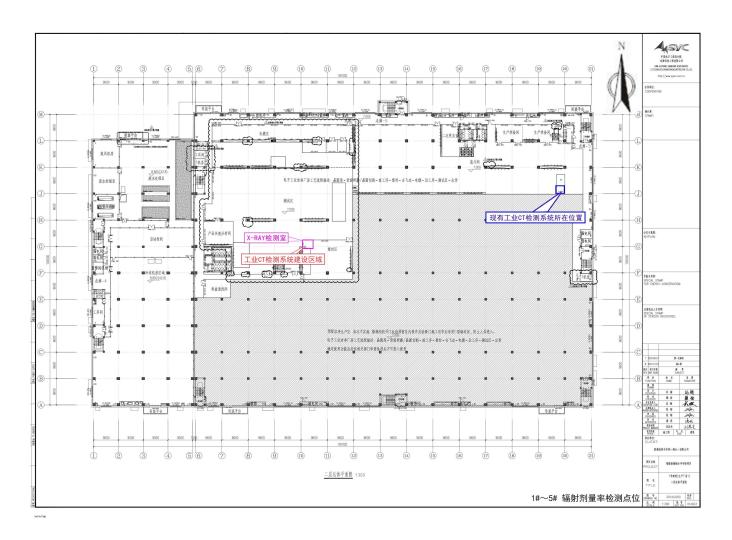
本项目所在生产厂房 1 二层平面布置示意图
